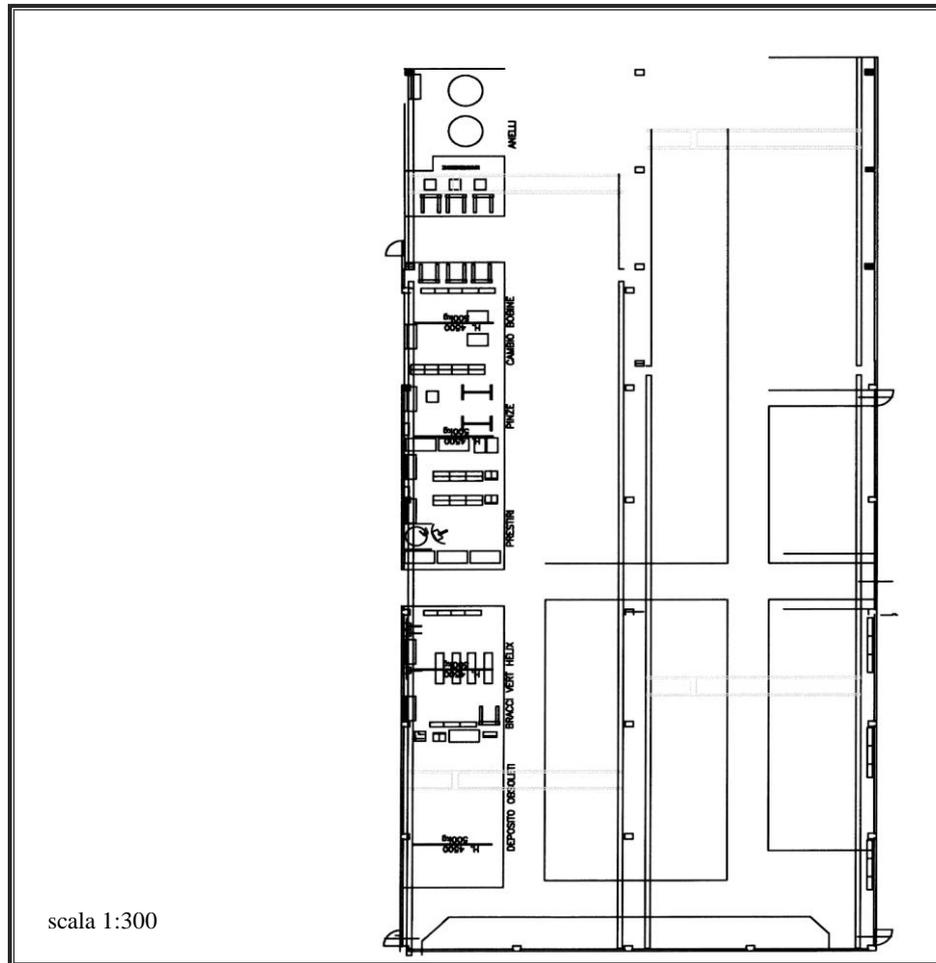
Planimetria dell'azienda Packaging (parte II)
